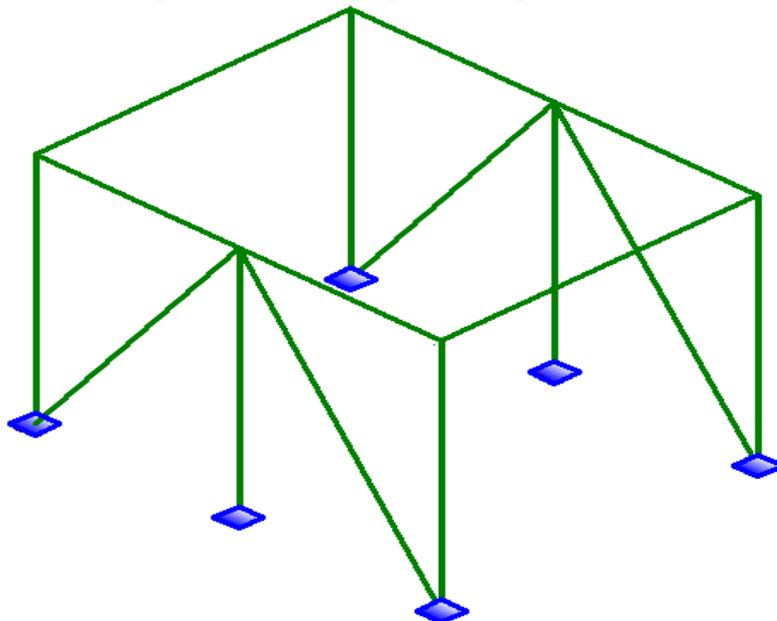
Configuración estructural de soporte módulo 04, pórtico en guadua.
